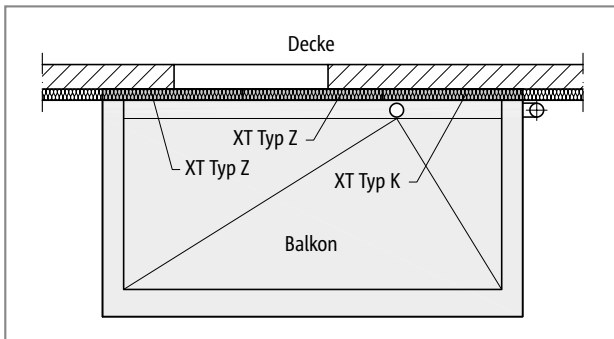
Schöck Isokorb® XT Typ Z, K: Aussparung für Entwässerung mit Schöck Isokorb® XT Typ Z
